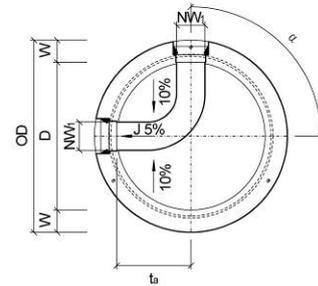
Grundriss CRENO Normschachtboden Typ 10
